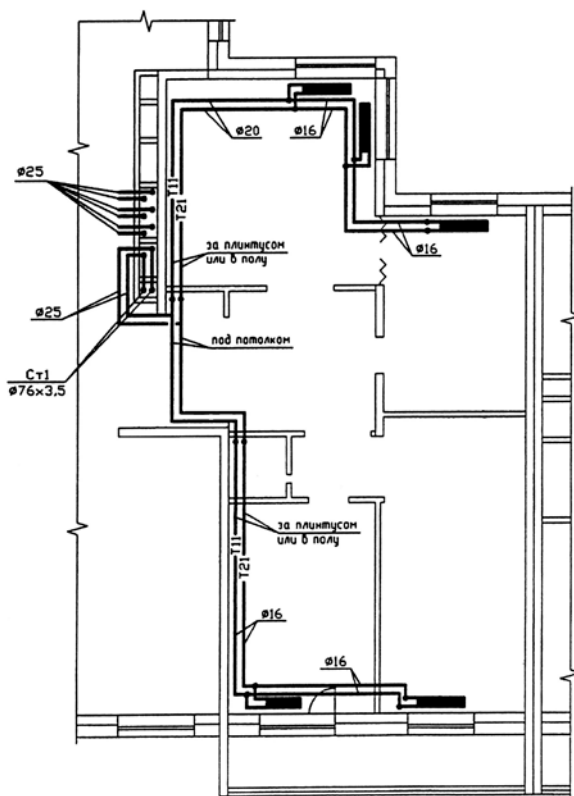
Система отопления с плинтусной разводкой теплопроводов по квартире
